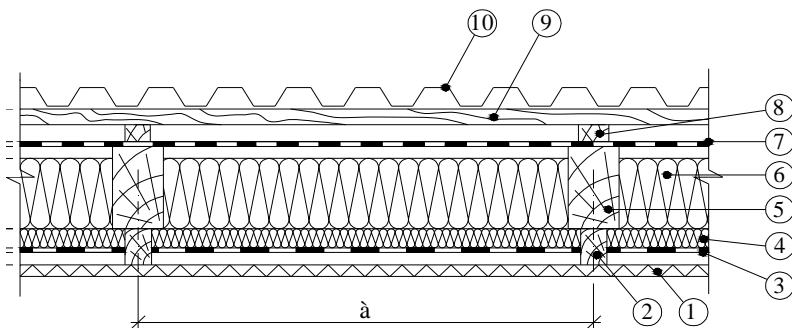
Схема «4». Вариант конструктивного решения устройства теплоизоляционного слоя и подкровельных пленок в конструкции покрытия. Утеплитель разделен на две части. Стропила изолированы снизу:
